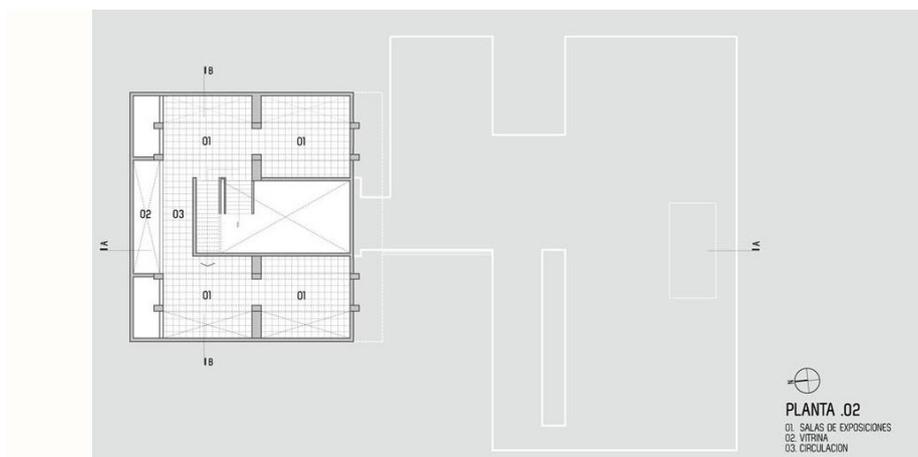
Planta del segundo nivel. Fuente: Archdaily, 2010. Elaboración: Imagen de Porta Guerrero, Paul (2010). Blog de Arquitectura Moderna.
